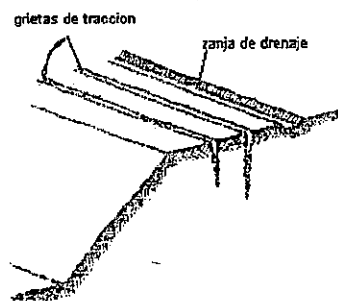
13 Disposición de zanjas de drenaje en un talud
